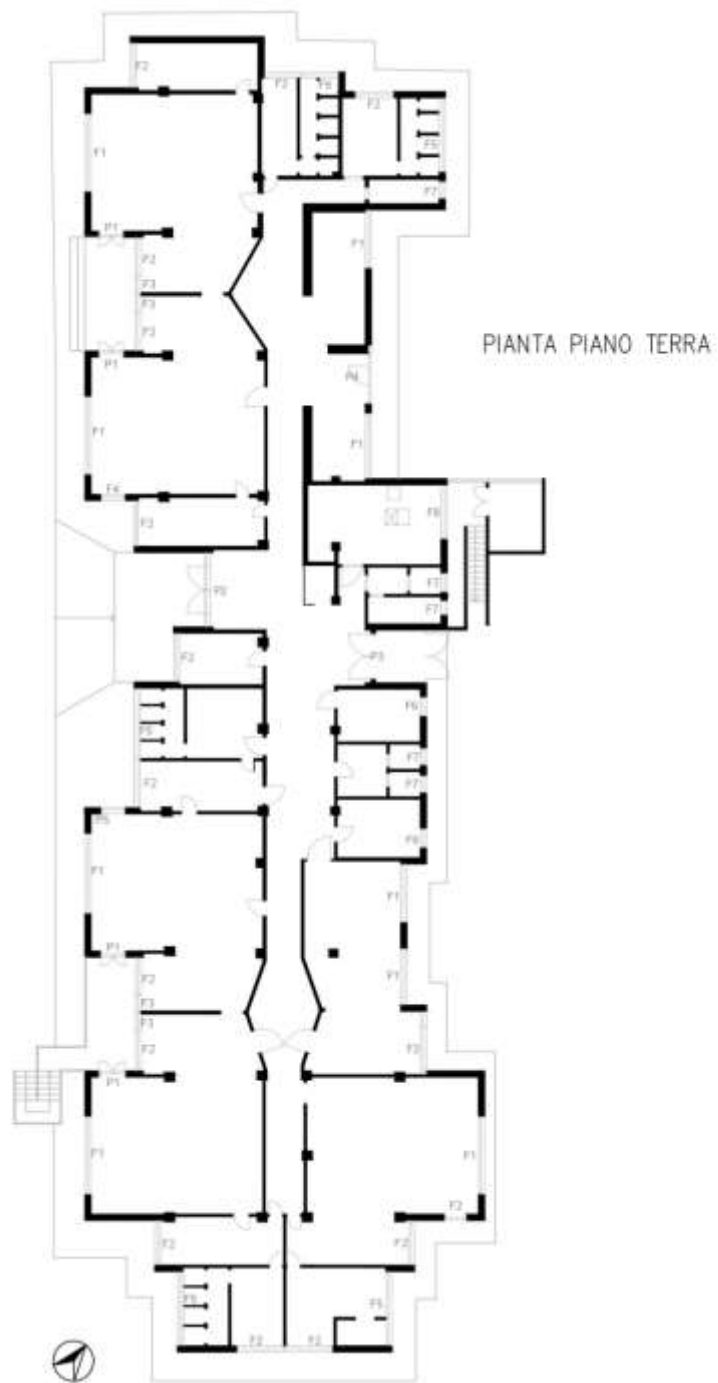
PIANTA PIANO TERRA - IDENTIFICAZIONE DELLE FINESTRE NEI LOCALI
